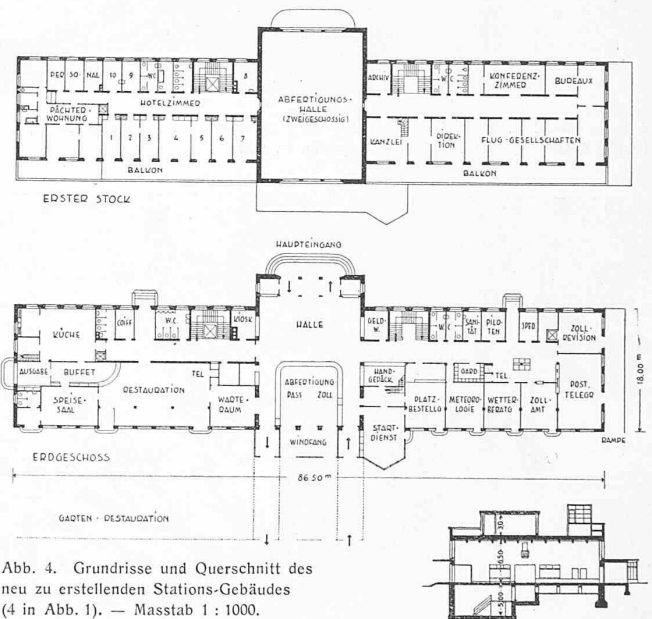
Grundrisse und Querschnitt des neu zu erstellenden Stations-Gebüdes (4 in Abb. 1). — Masstab 1 : 1000.
